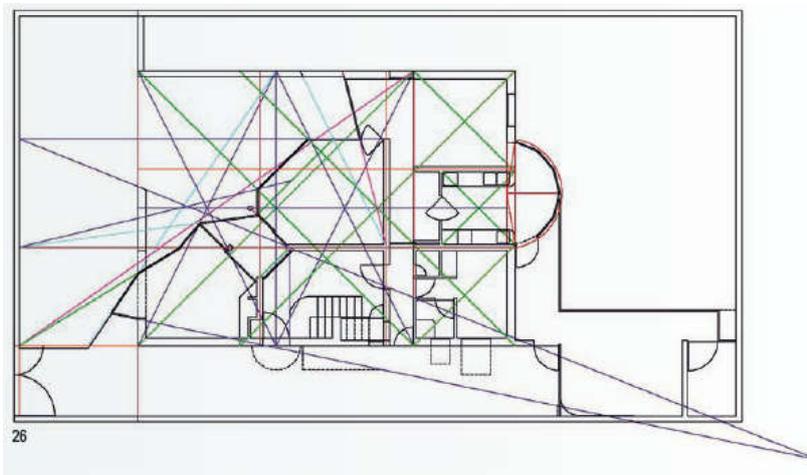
Sistemas geométricos – Planta baixa do térreo – Casa Beires. Fonte: GARCÍA (2014)
